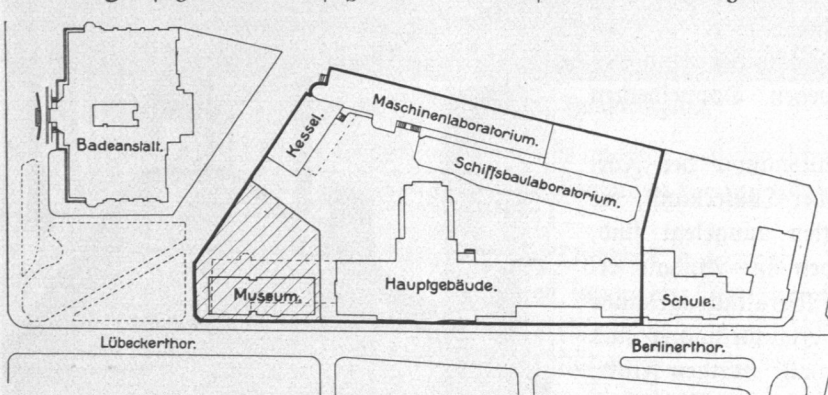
Lageplan der Technischen Staatslehranstalten.
